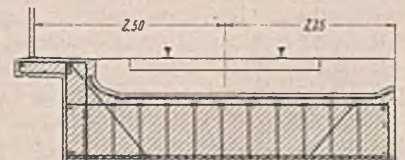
Querschnitt einer Eisenbeton-Plattenbrücke.
